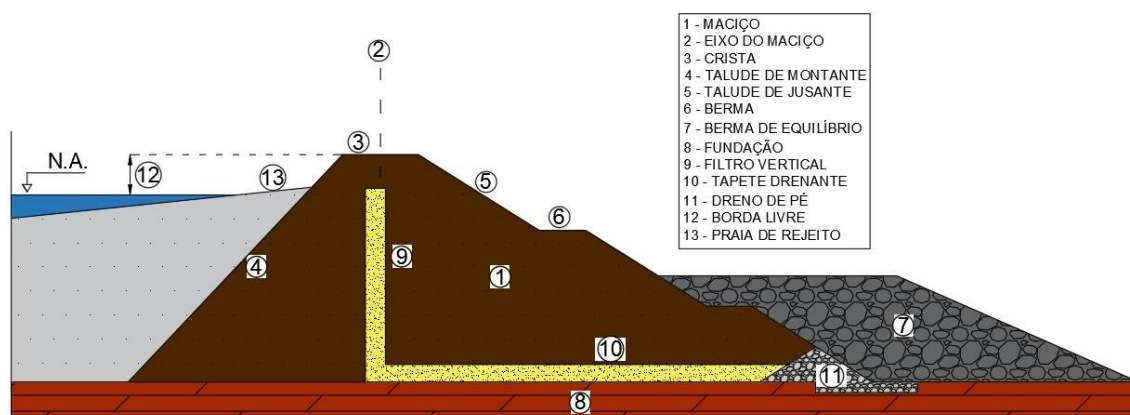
Elementos estruturais de uma barragem de terra. Fonte: Feam.
